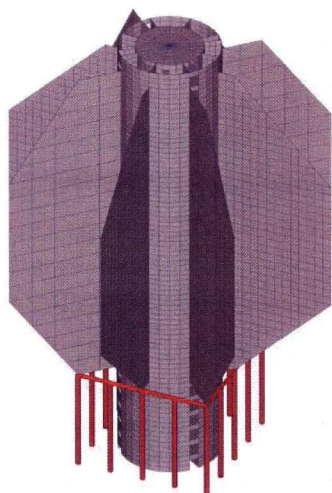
Вариант 3 конструктивной схемы здания книгохранилища (несущими элементами, воспринимающими нагрузку от элементов каркаса, являются круглый железобетонный ствол с 8-ю диафрагмами и трубобетонные колонны)
